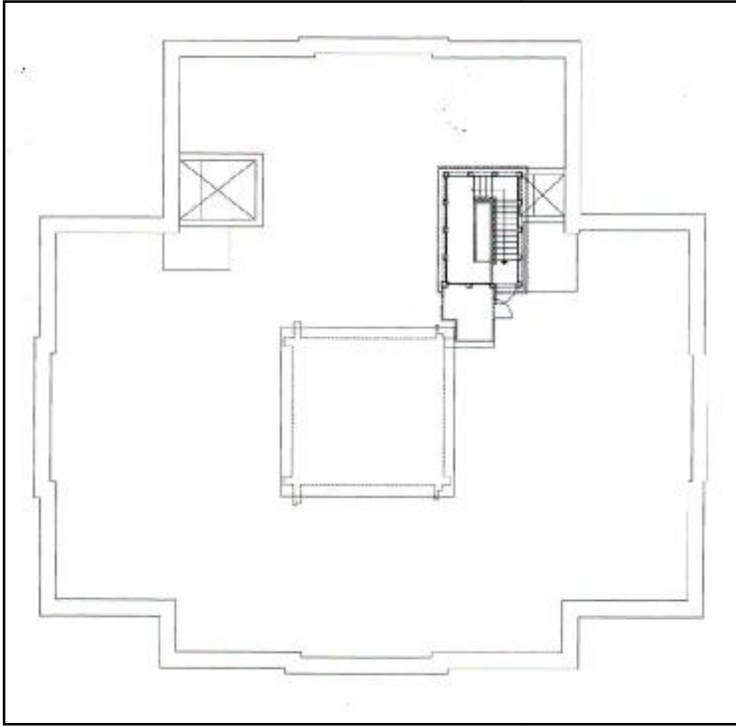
دور الميزانين الأول - مسقط أفقى - عن المجلس الأعلى للآثار
